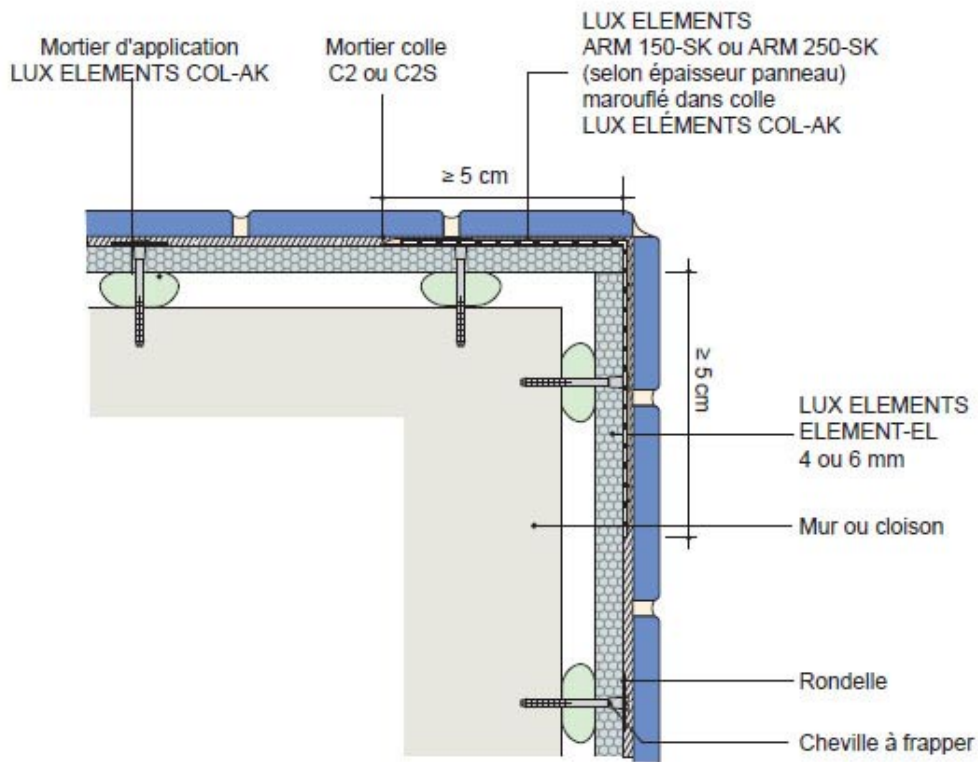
Exemple de traitement d'un angle mur/mur sortant en local EA ou EB : Panneaux collés en plein. En local EB+ privatif ou EB+ collectif, la bande LUX ELEMENTS-ARM 150 SK ou ARM 250 SK est remplacée par la bande LUX ELEMENTS-DRY DB et le mortier LUX ELEMENT-COL AK par le mortier LUX ELEMNT-DRY ASK
